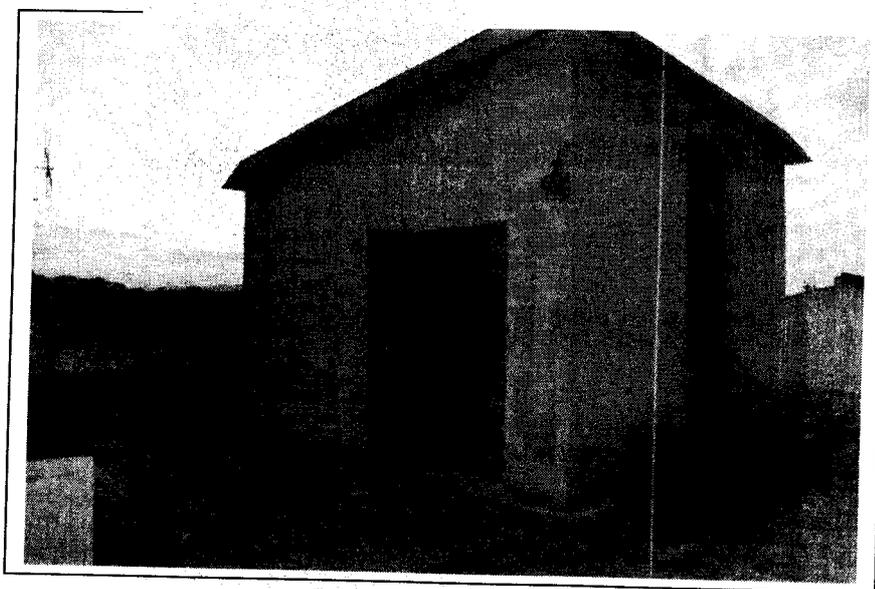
particolare torrino montacarichi a piano secondo e vista di porzione del terrazzo esclusivo.
